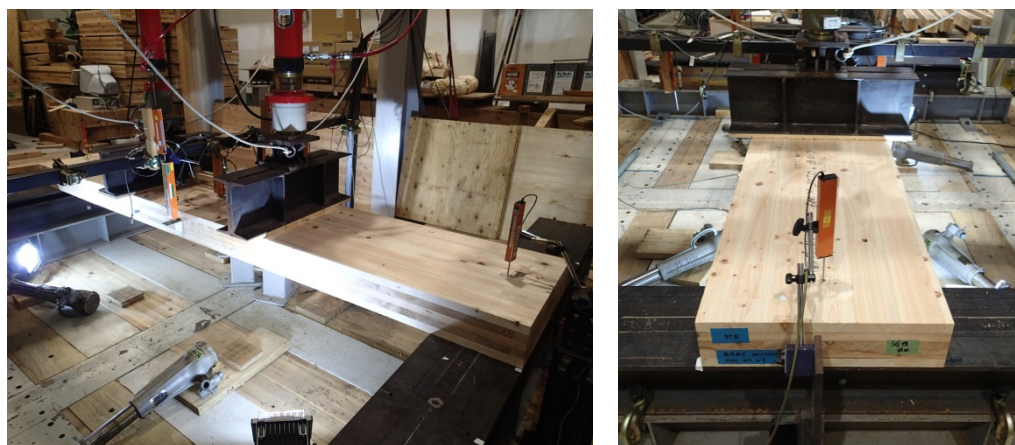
面外曲げ試験状況 (幅 600mm)
